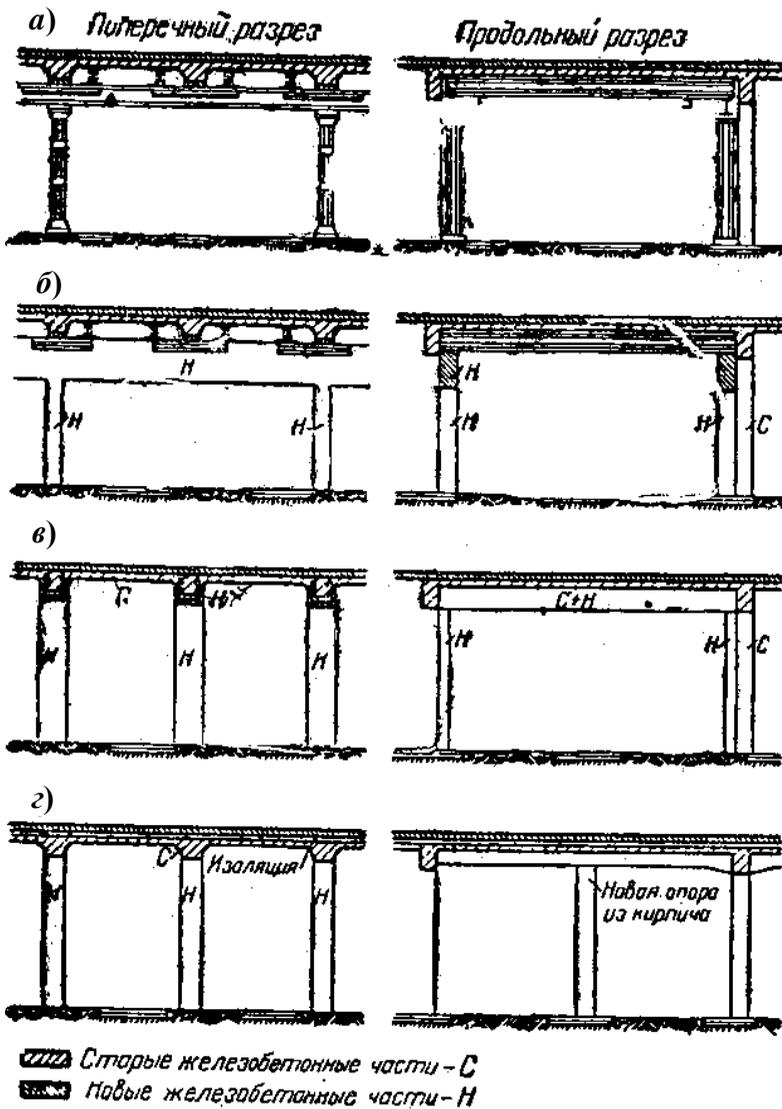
Четыре варианта проекта усиления железобетонного перекрытия дома в Будапеште
